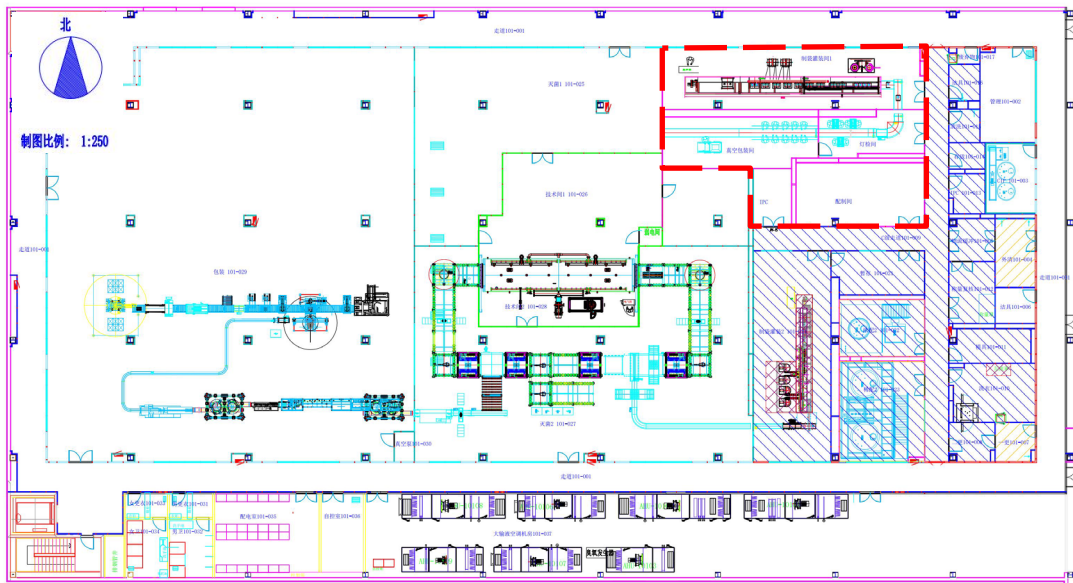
6#厂房二层平面布置图（红色虚线范围为本项目位置）
